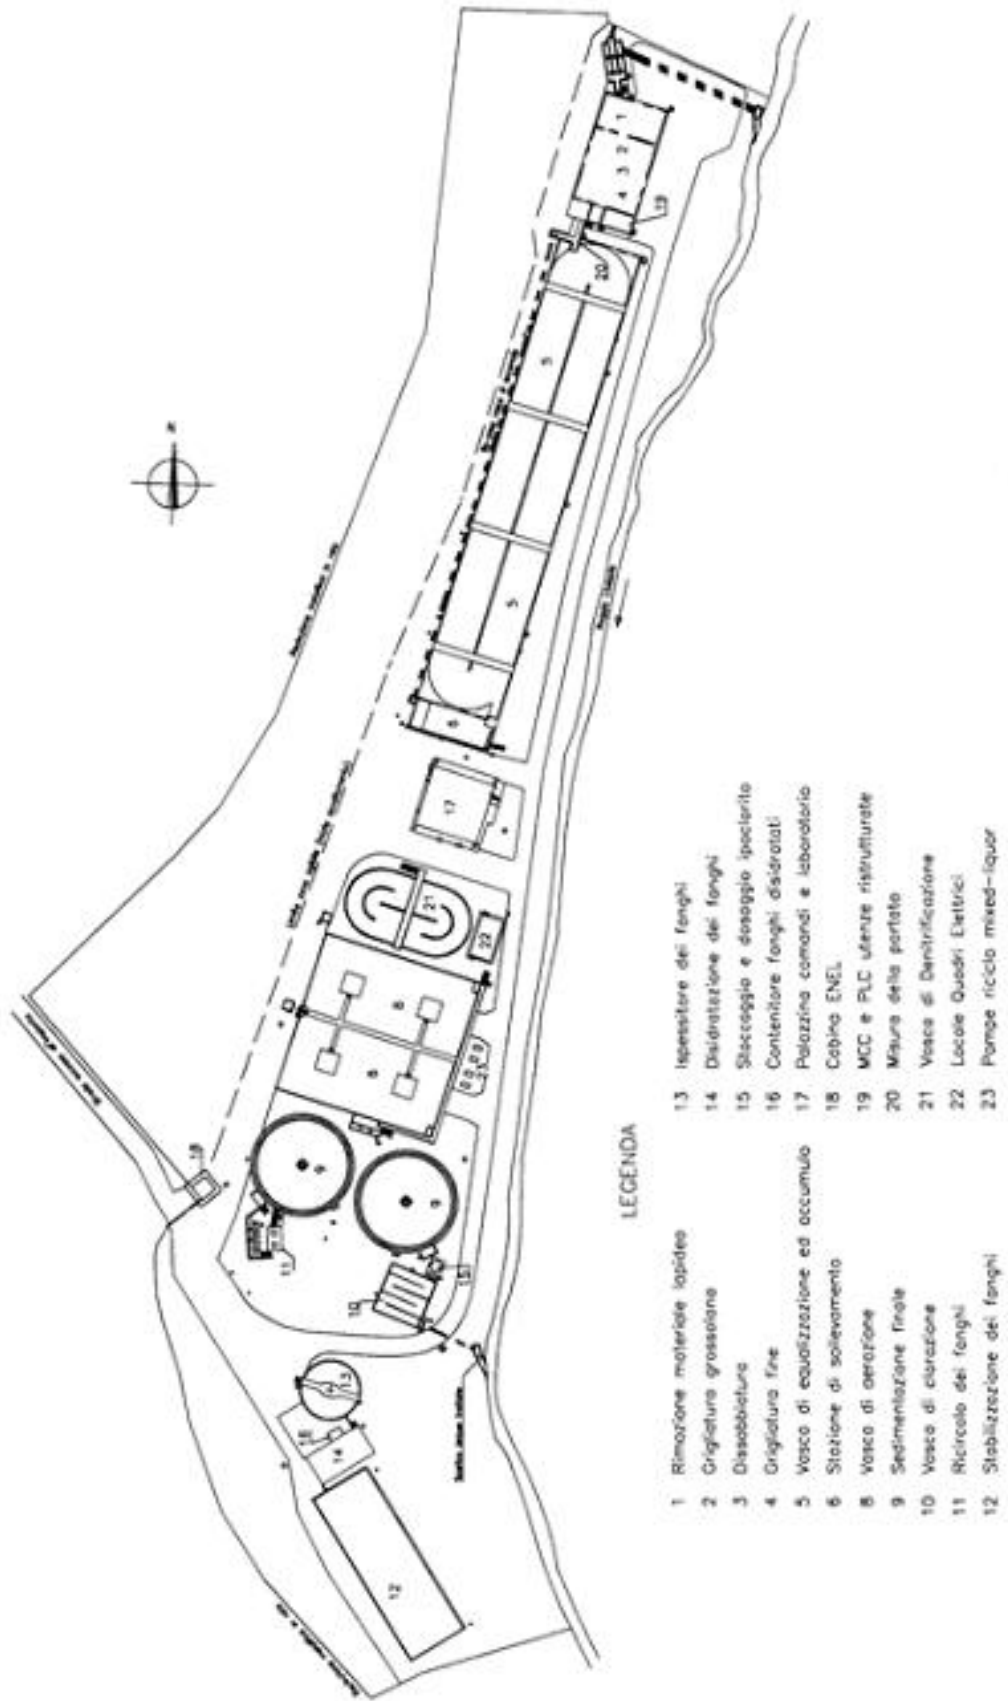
Planimetria dell'impianto di depurazione Livescia.
